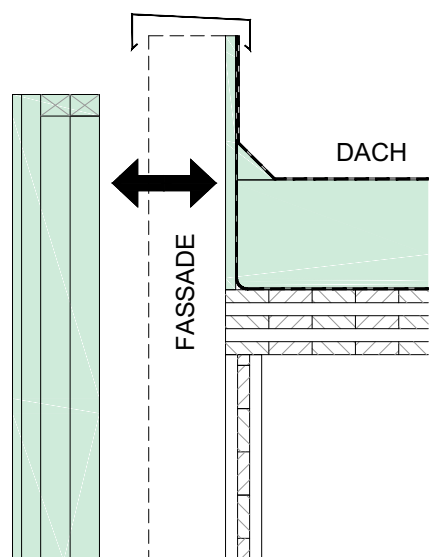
Prinzip-Darstellung: Funktionstrennung Fassade hinterlüftet und Dachaufbau auf Basis Abb. 9.9 nach Abb. 7.10
